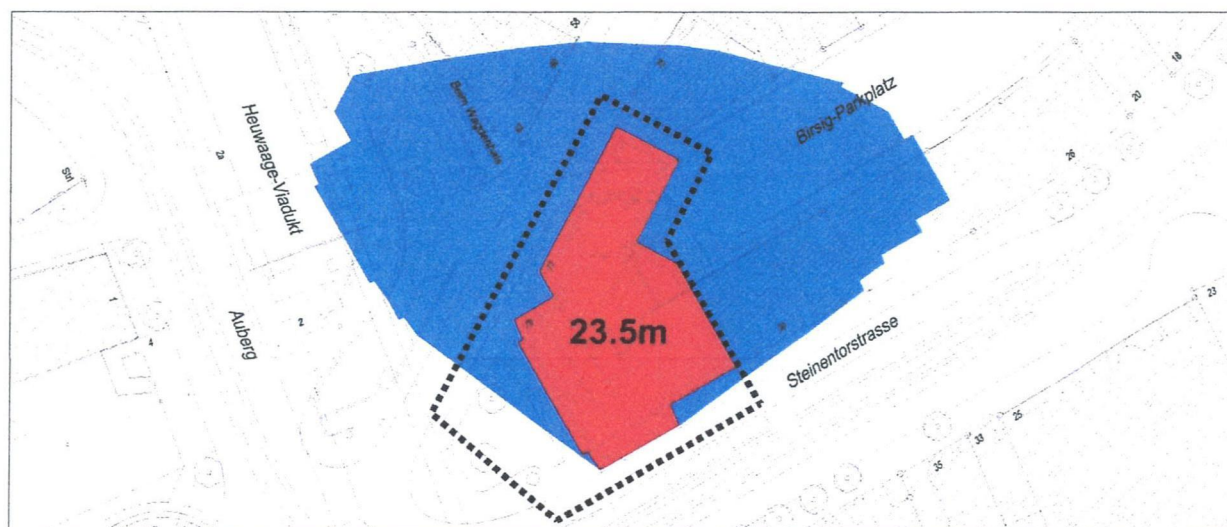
2 Stunden Schatten einer zonenkonformen Bebauung in der Zone 6. Höhe = 23.5 m. (Kein Massstab, Plan genordet)
